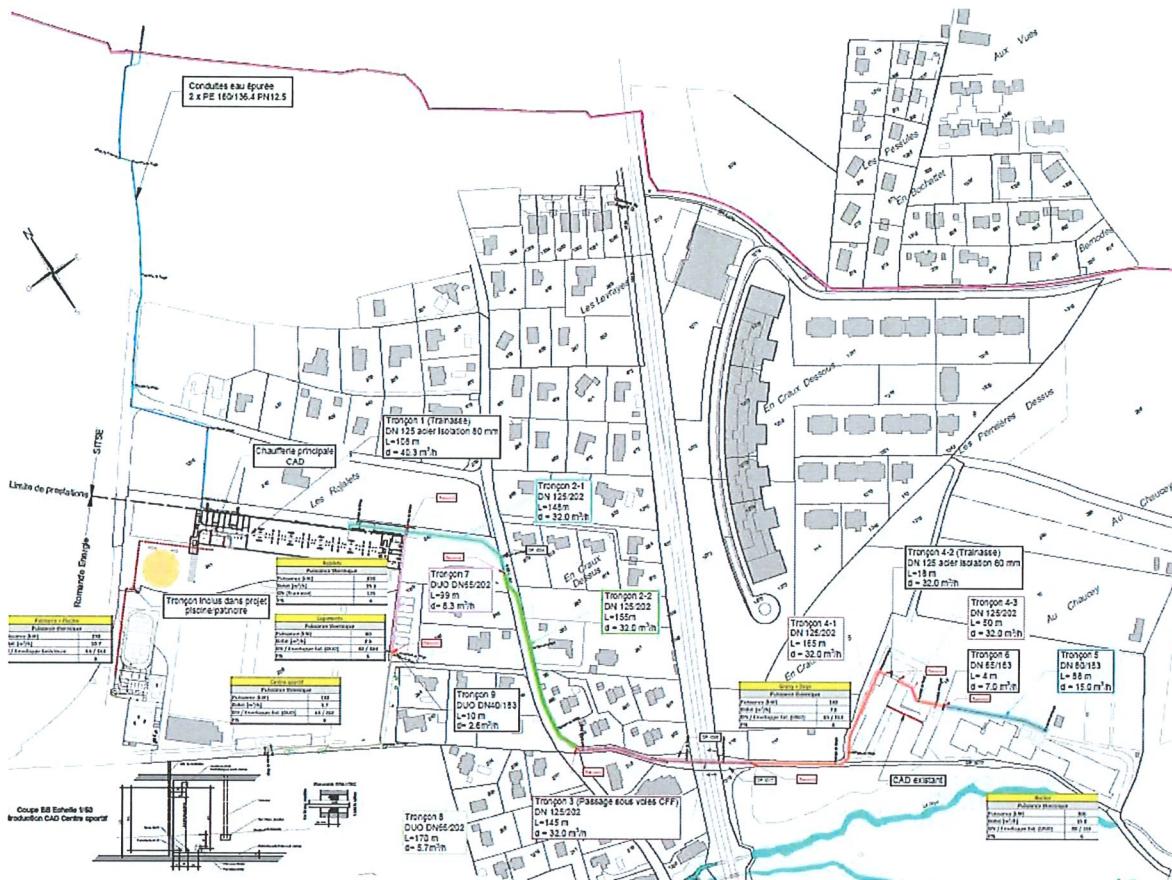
Plan du réseau existant du CAD Rojalets et de la conduite d'eau épurée
